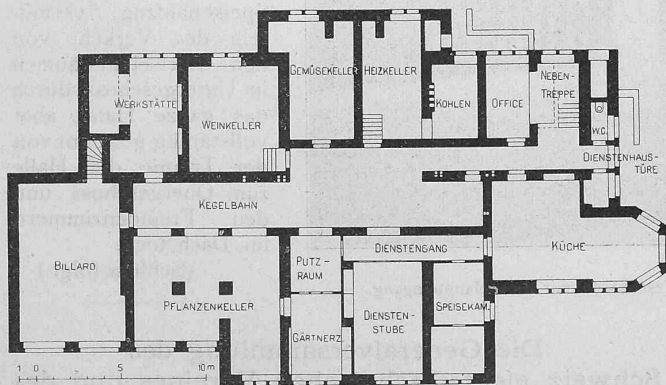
und 4. Grundrisse vom Untergeschoss und Erdgeschoss. — Masstab 1:400.
